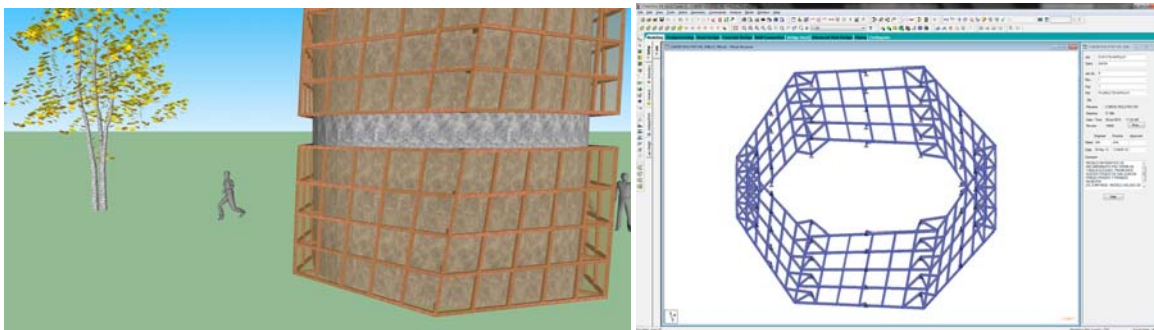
Vista parcial del arreglo de bastidores metálicos que se anclan al muro de concreto. Modelo elaborado en STAAD.Pro V8i
